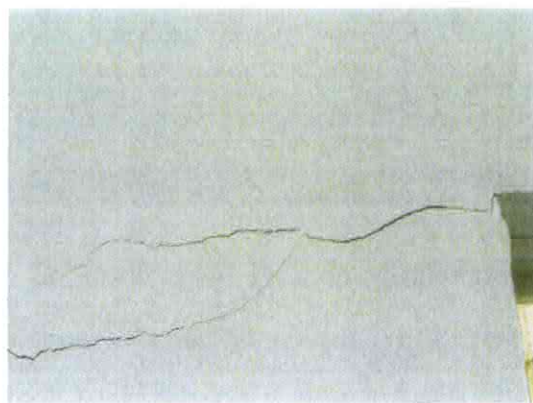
Widok na strukturę ściany fundamentowej pod ścianą działową w pomieszczeniu archiwum
